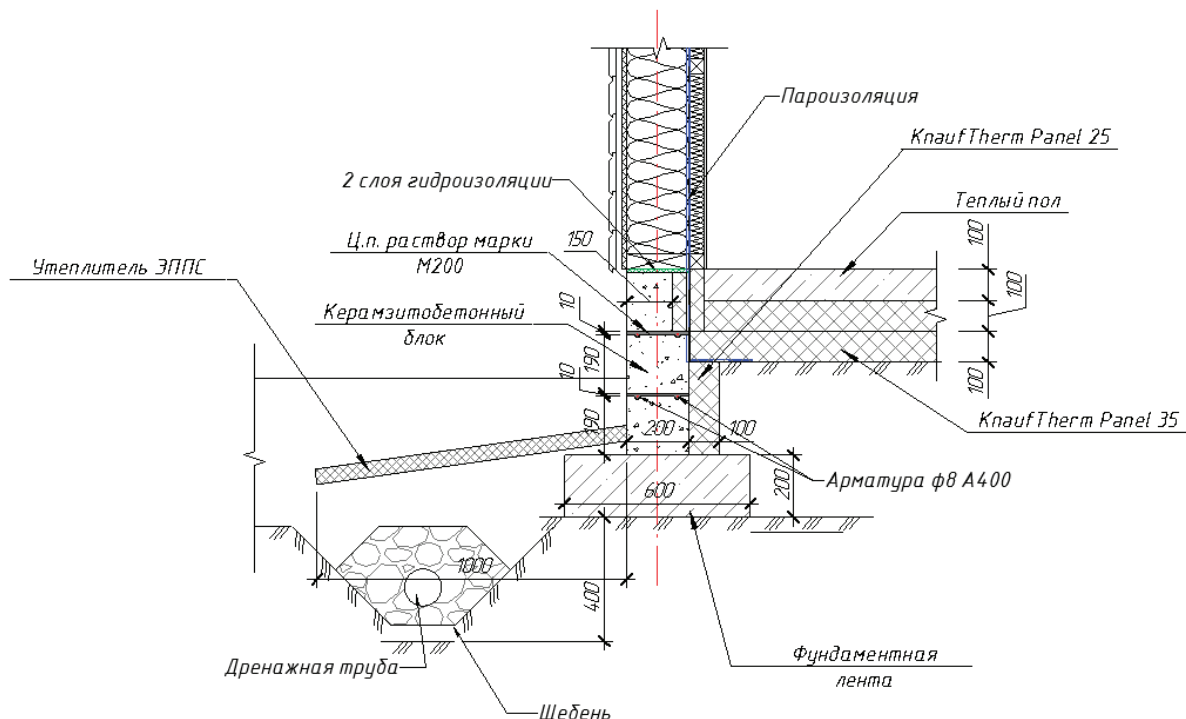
Фундамент типа УФФ (Утепленный финский фундамент)
